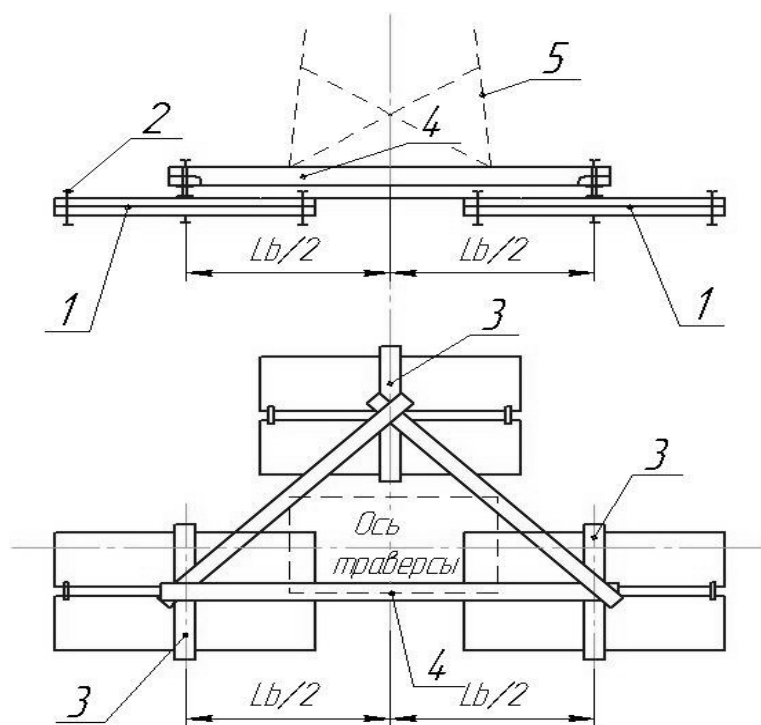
Пример опирания опоры ВЛ на поверхностные фундаменты:
